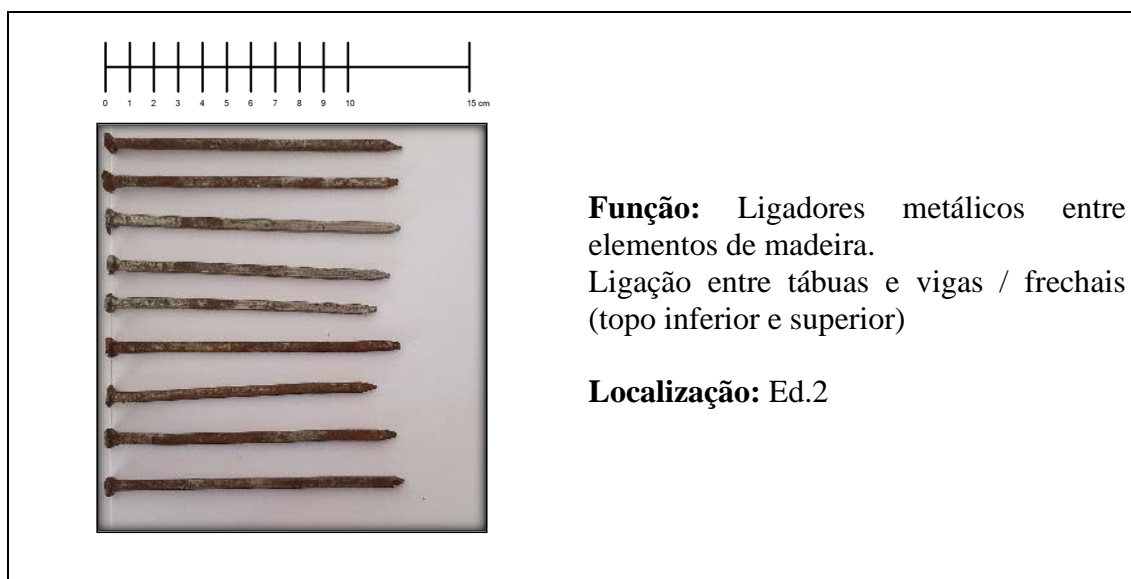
Ligadores metálicos de ligação entre tábuas e vigas / frechais do Ed.2
